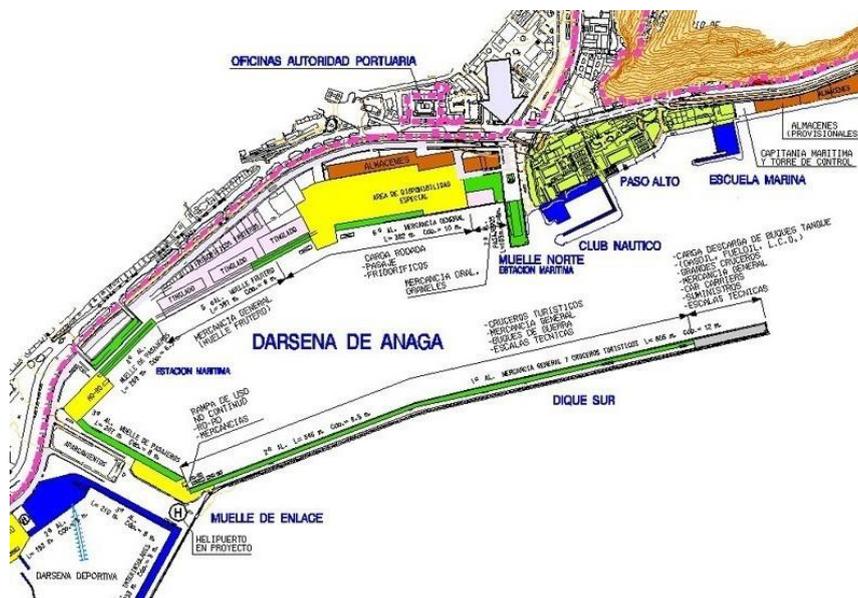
Plano dársena de Anaga. Fuente: (12)
